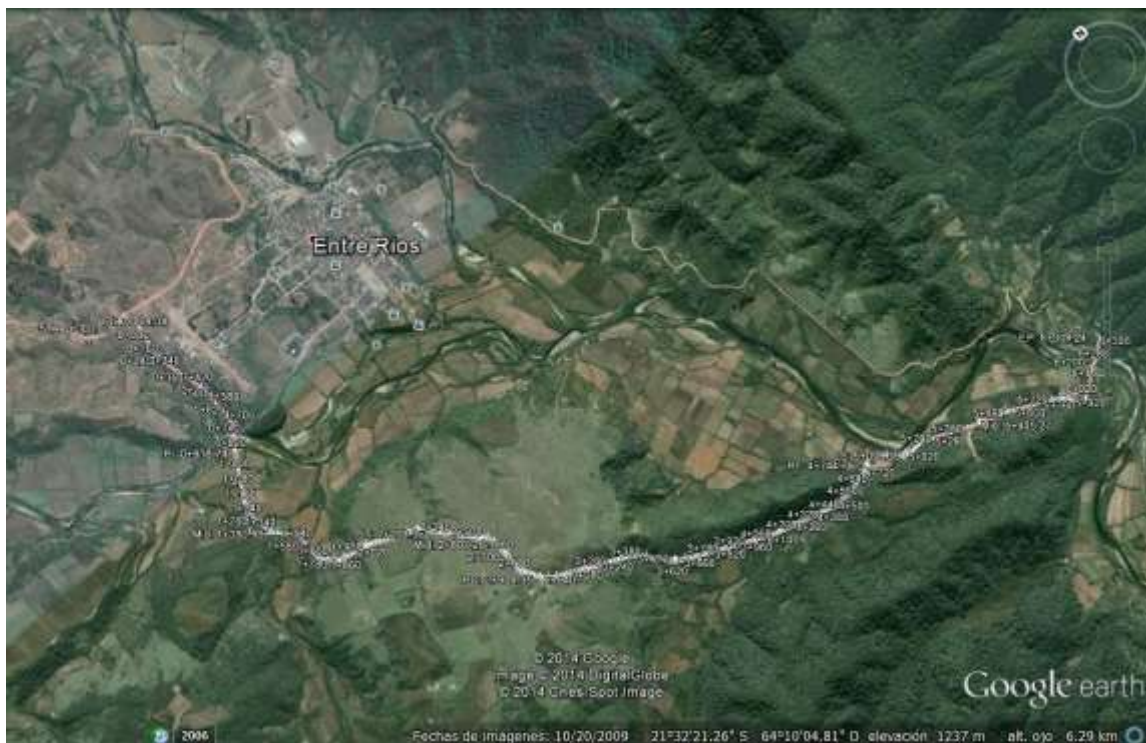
Planteamiento y trazo vial Alternativa II (Fuente: Imagen Google Earth;
